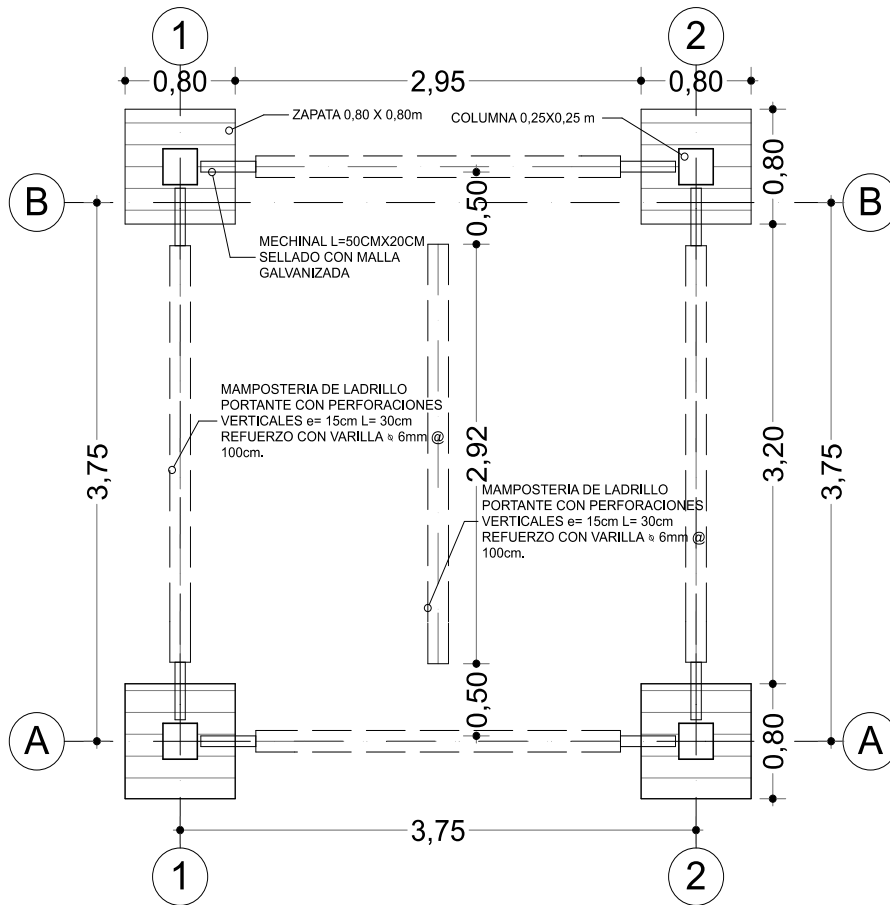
PLANTA DE CIMENTACION PROPUESTA
